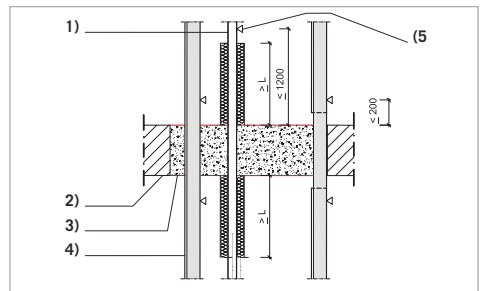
Unterstüztung von Rohren und Kabeln / Kabeltragekonstruktionen in Decken
